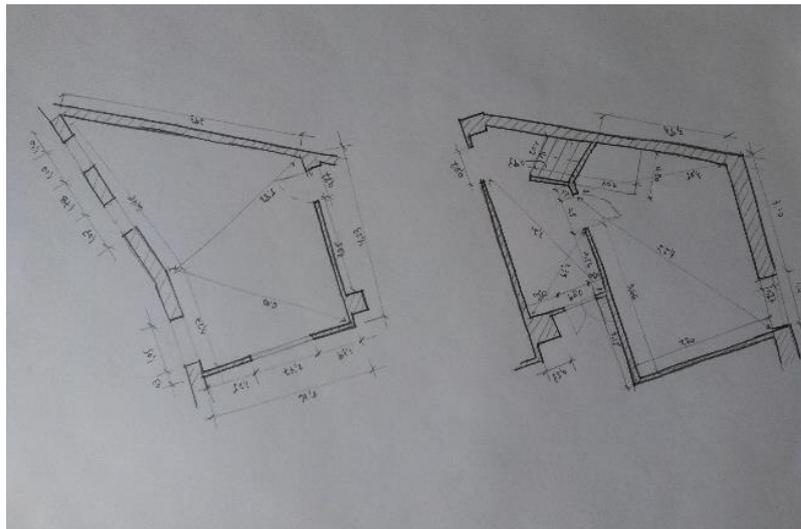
Croquizado de estancias planta primera. Fuente Propia.
